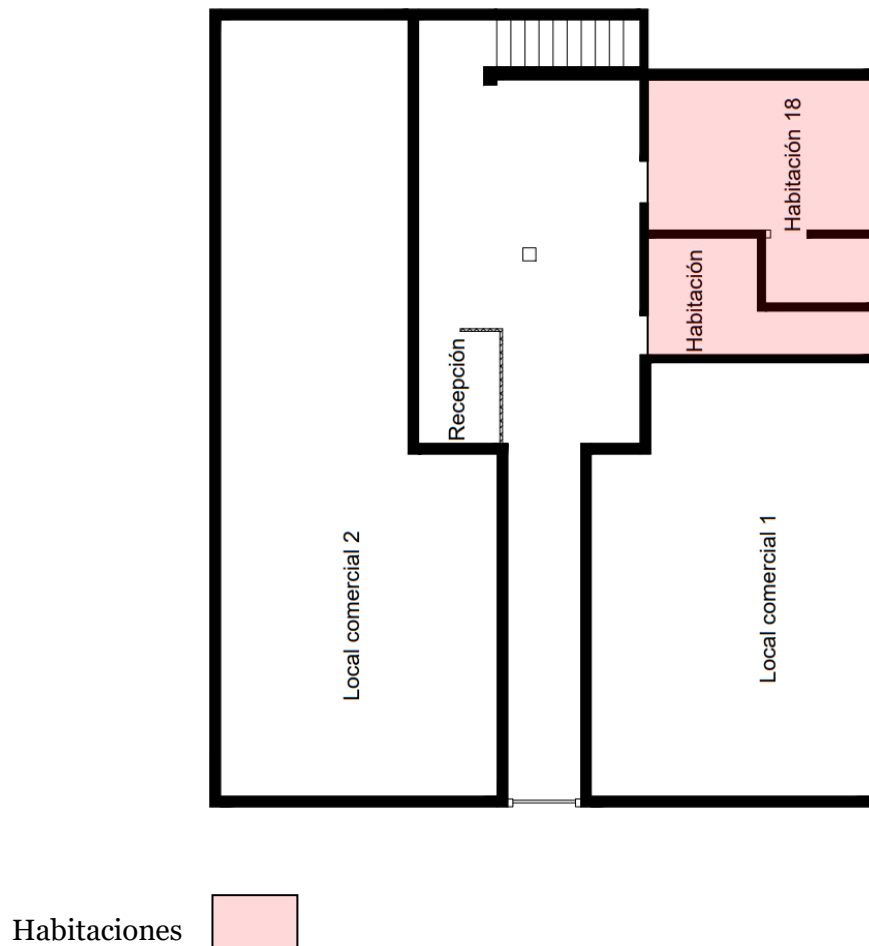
primera planta actual. Fuente: elaboracion propia.
